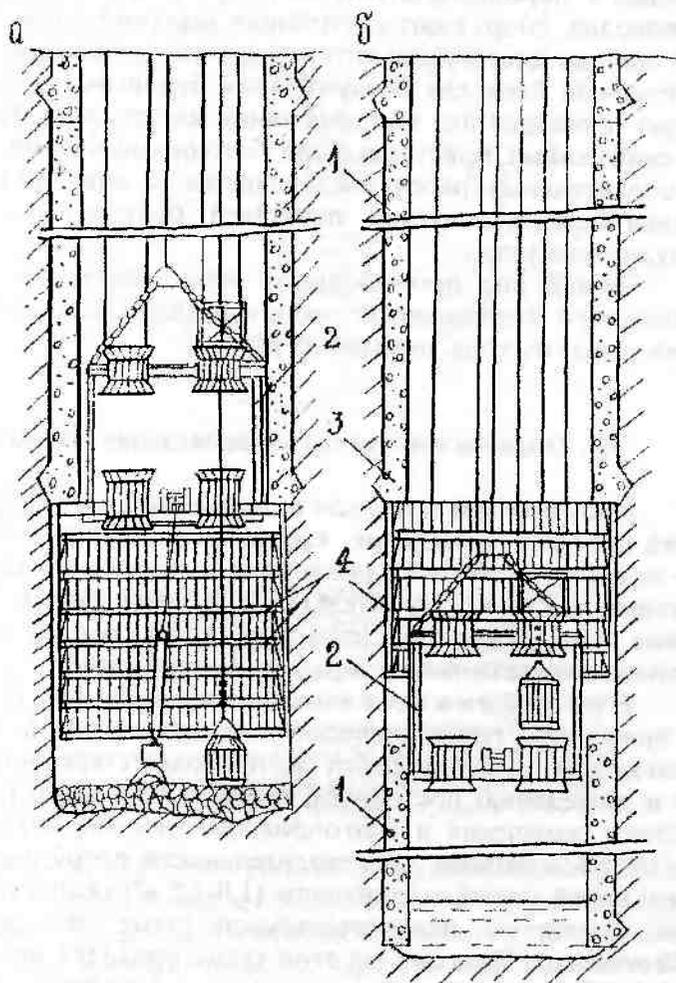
Проходка ствола по последовательной схеме: а - проходка звена с временным креплением; б - возведение бетонной крепи
